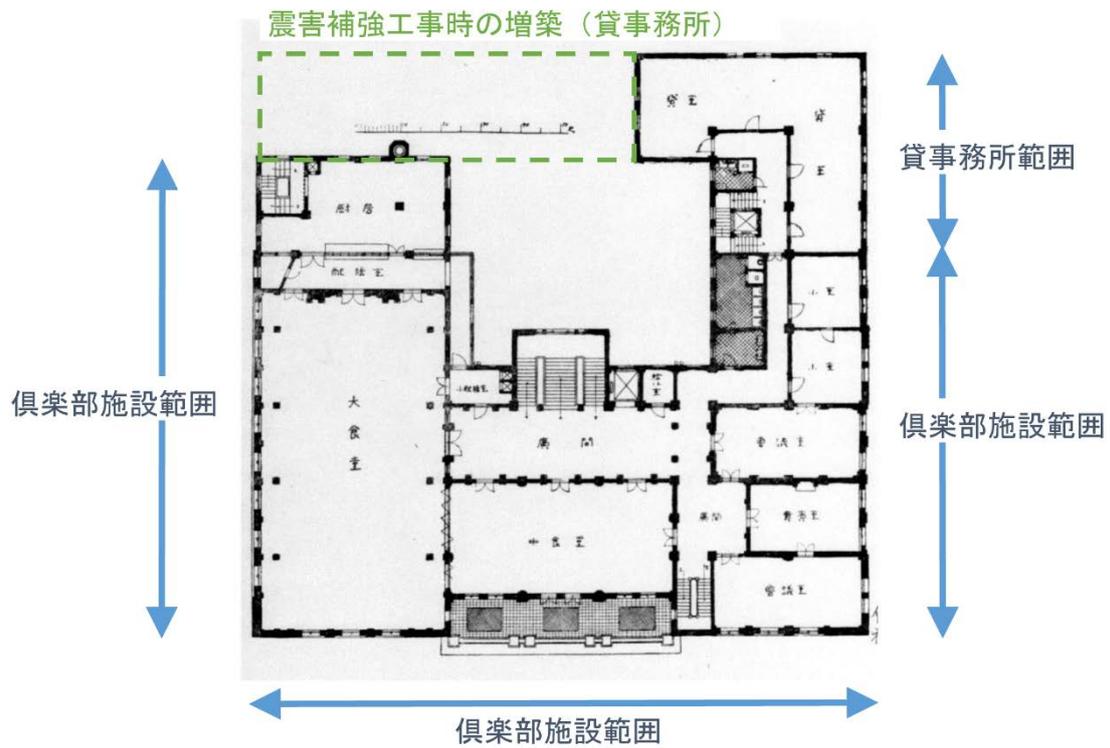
旧建物（当初）3階平面図 （日本工業倶楽部所蔵）
